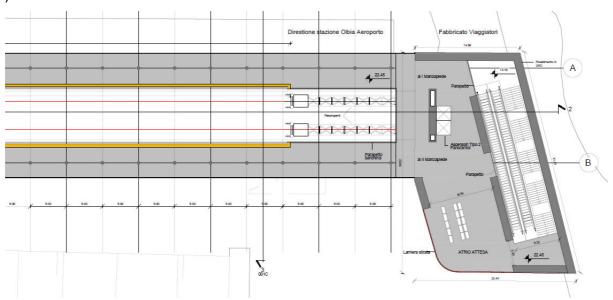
Stralcio planimetria quota banchina del fabbricato viaggiatori della stazione
